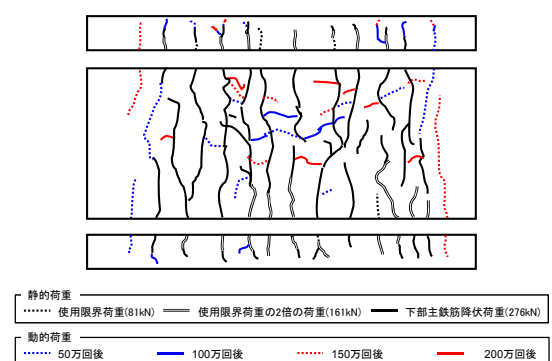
鉄筋付型枠床版に生じたひび割れ
